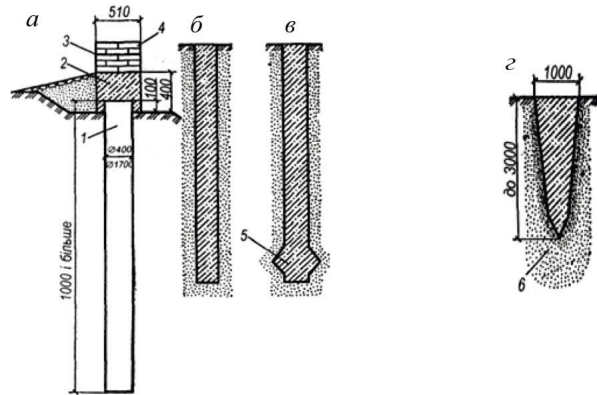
Набивні палі та фундаменти у витрамбованих котлованах:
